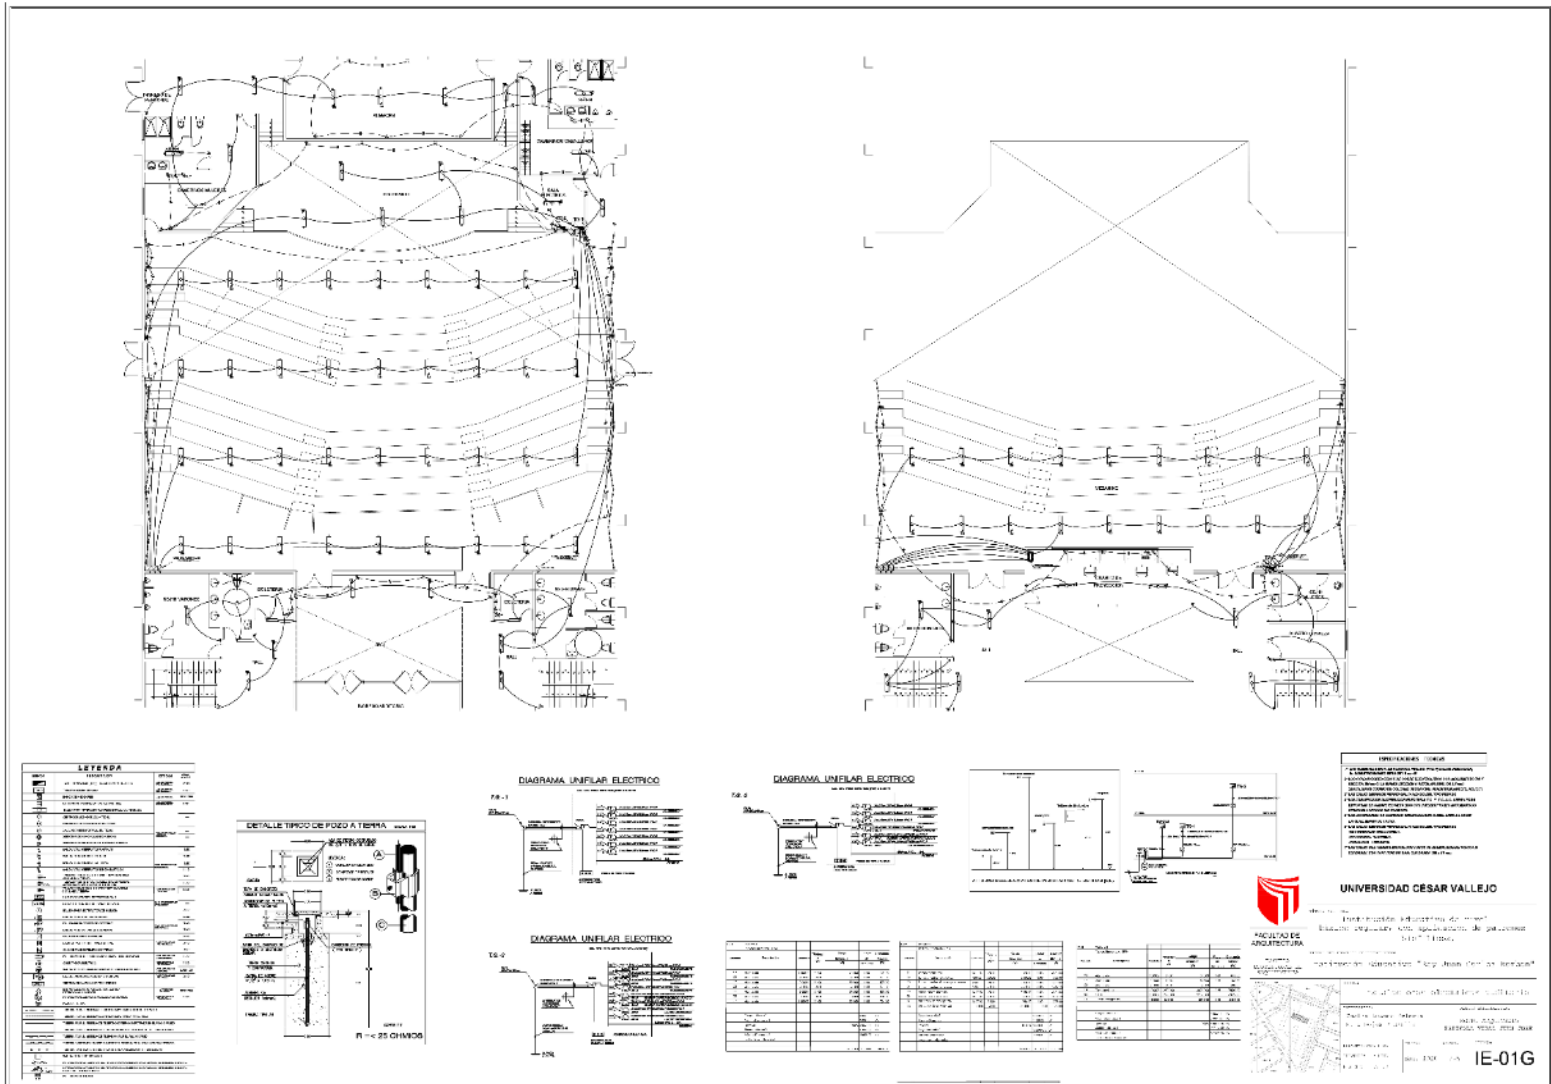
Plano alumbrado bloque "G", Fuente: elaboración propia
